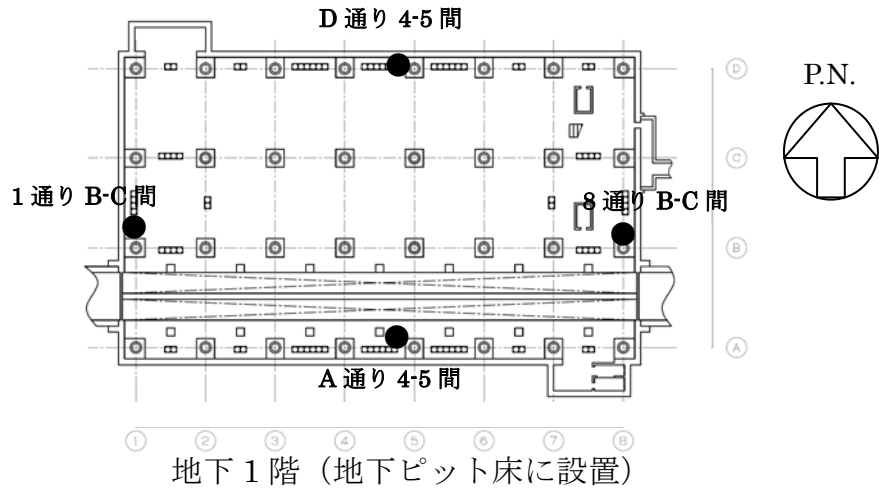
(1) 地震計配置 (UC 建家 断面図)
